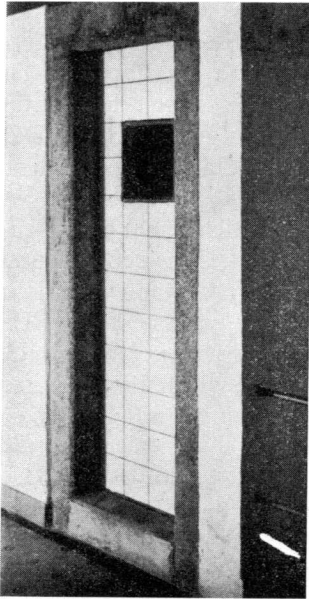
Eingangstüre mit Fenster zu einem Dampfbad. Türe und Inneres des Dampfbades geplättelt
